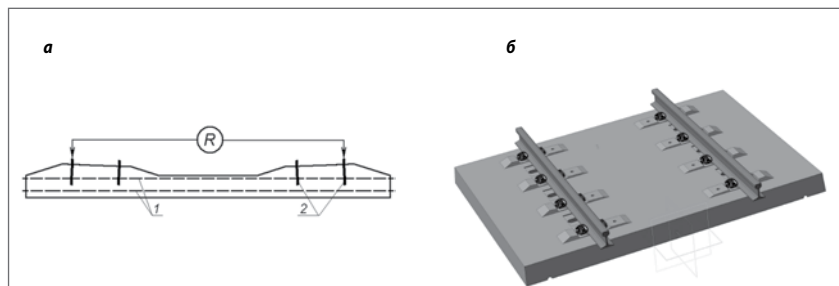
Схема вимірювання електричного опору залізобетонних шпал (а): 1 — розташування арматурного пакета; 2 — закладні болти скріплення КБ або анкери скріплення КПП-5 і УС-1; (б) колія на безбаластному мостовому полотні із скріпленнями PRS-4
